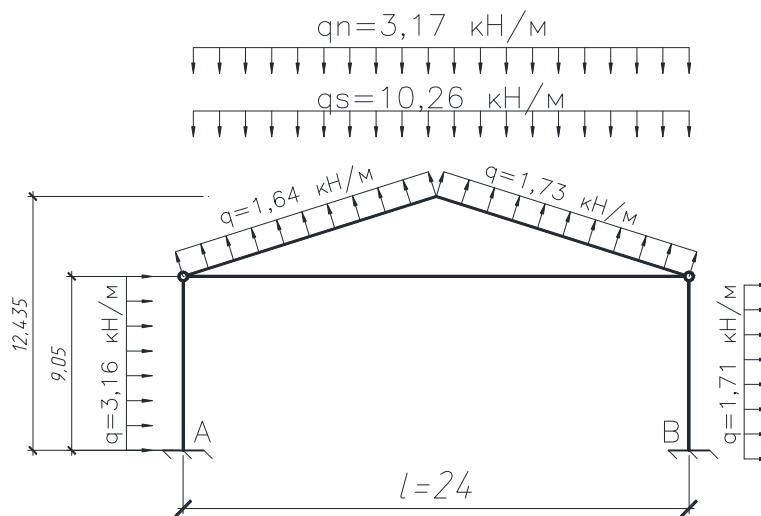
Розрахункова схема поперечної рами каркаса будівлі
